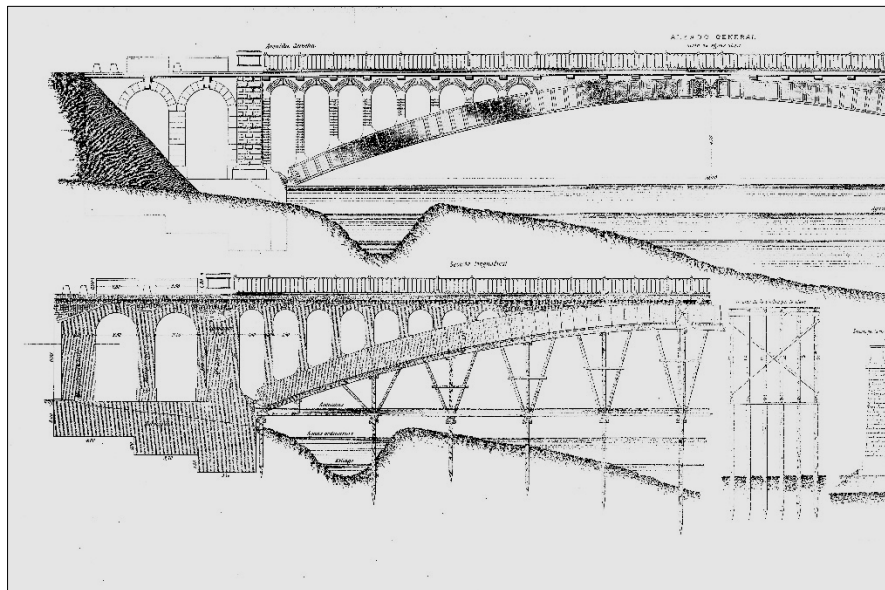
Planos del proyecto de puente de Las Segadas publicados en la Revista de Obras Públicas
